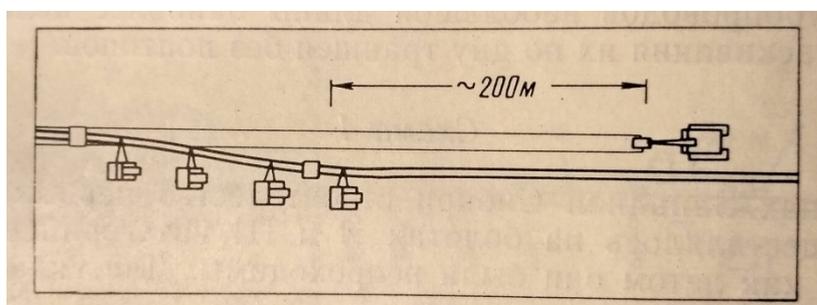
Совмещенный способ укладки трубопровода на болоте [2]
